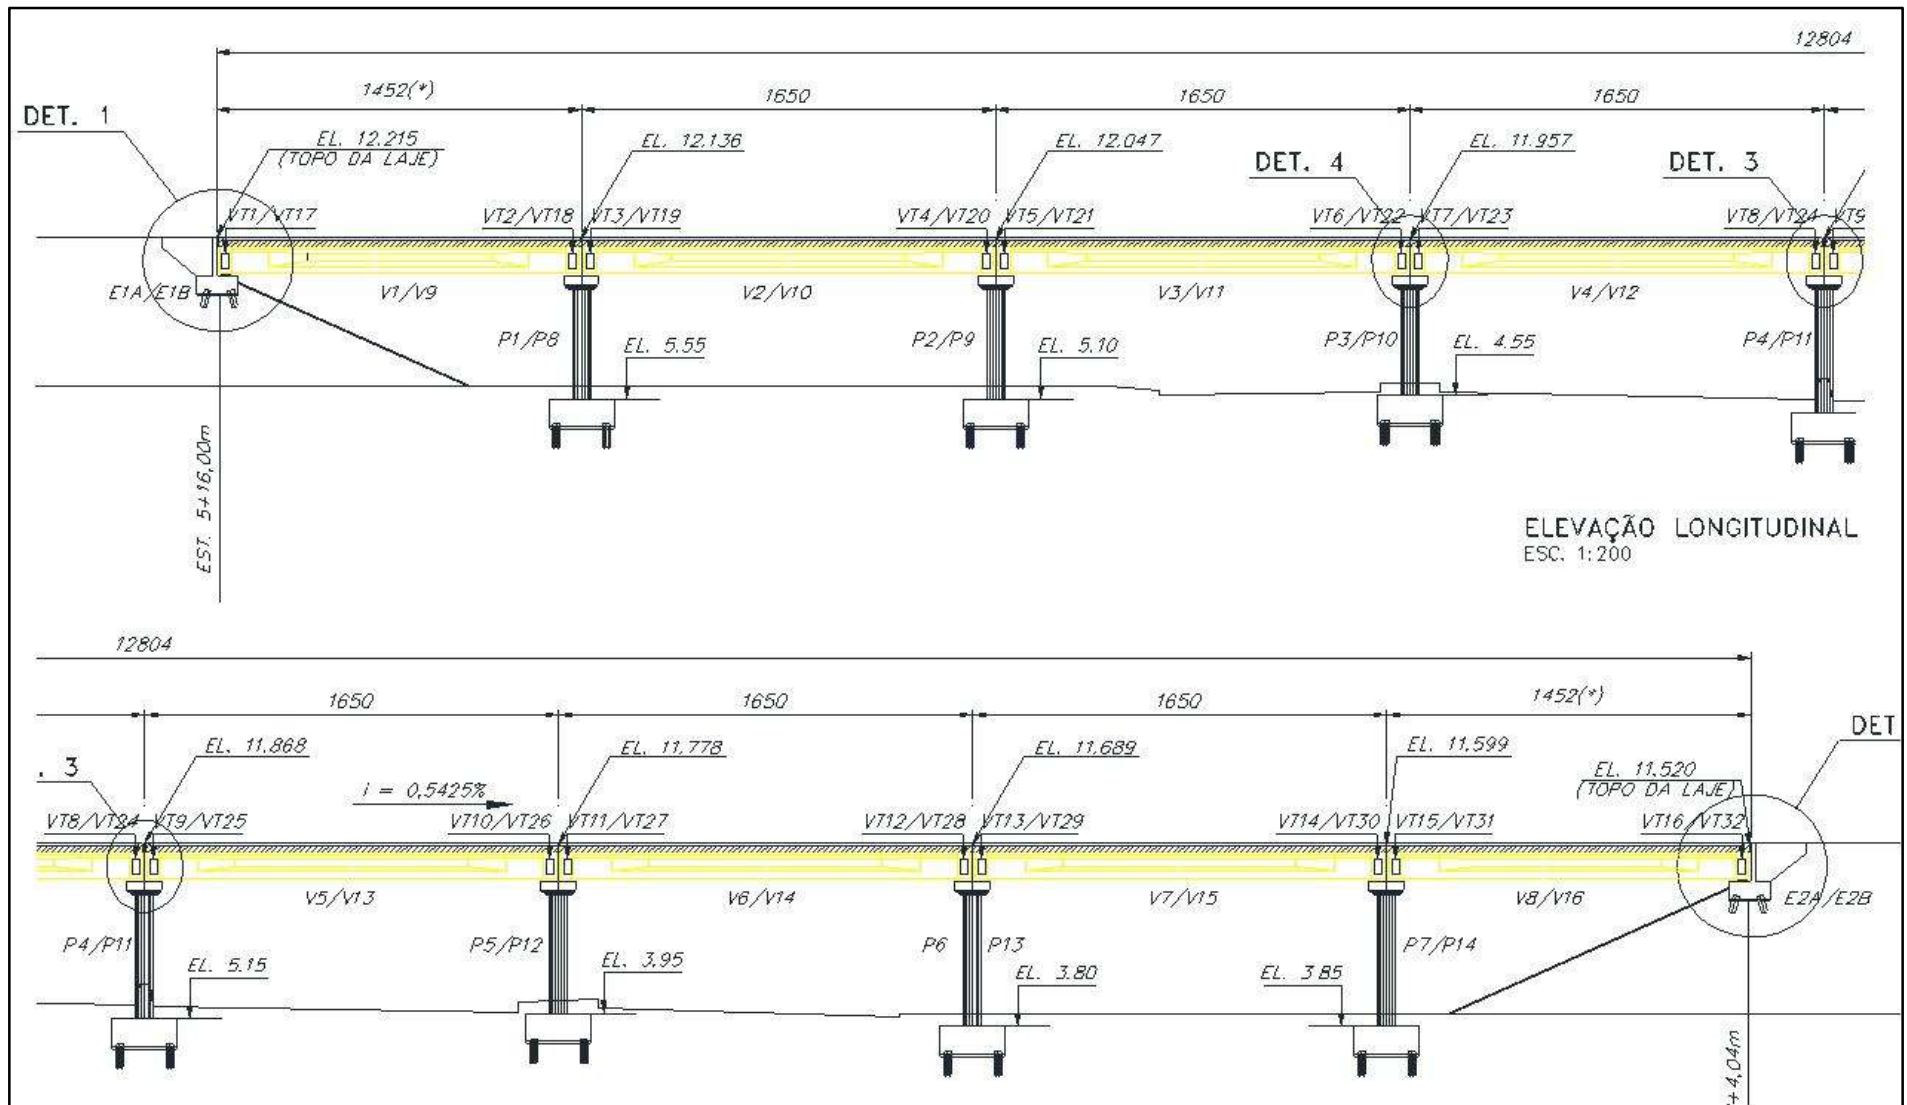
Posicionamento e numeração das vigas longarinas e transversinas, pilares e encontros
